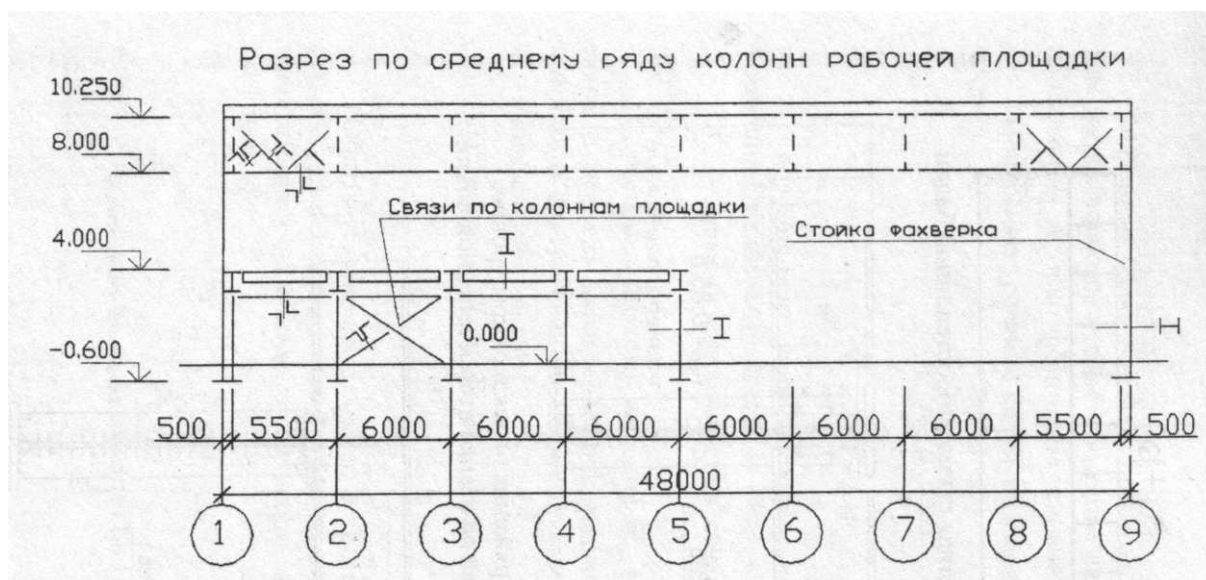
Связи по среднему ряду колонн рабочей площадки в здании длиной 48 м. Шаг колонн (шаг главных балок площадки) 6 м
